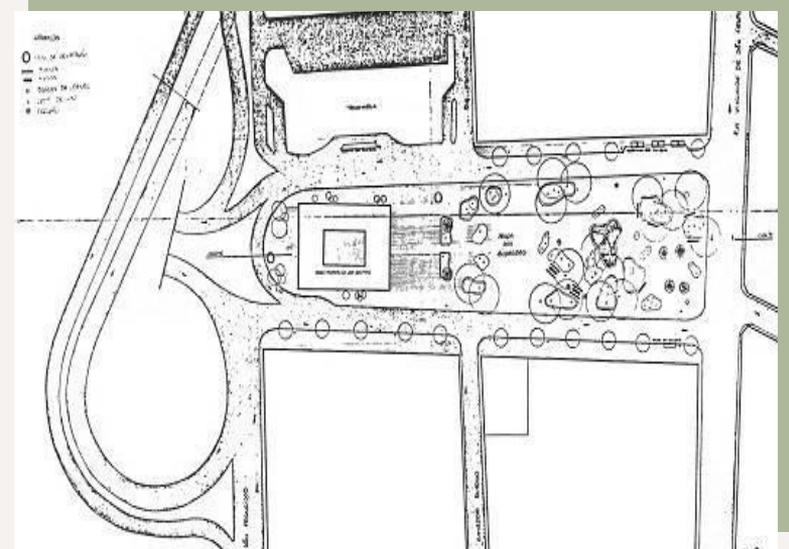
PLANTA SITUAÇÃO DO PROJETO DE RESTAURO DO TEATRO GUARANY.
